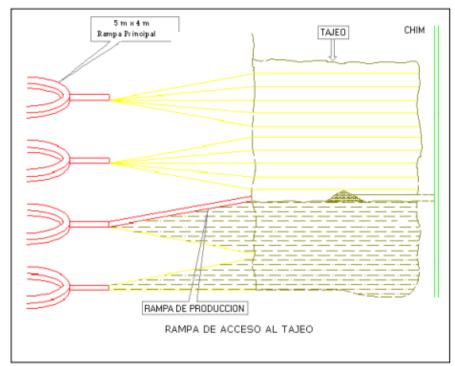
Rampa de acceso al tajeo Tomado del Departamento de Planeamiento de Mina
